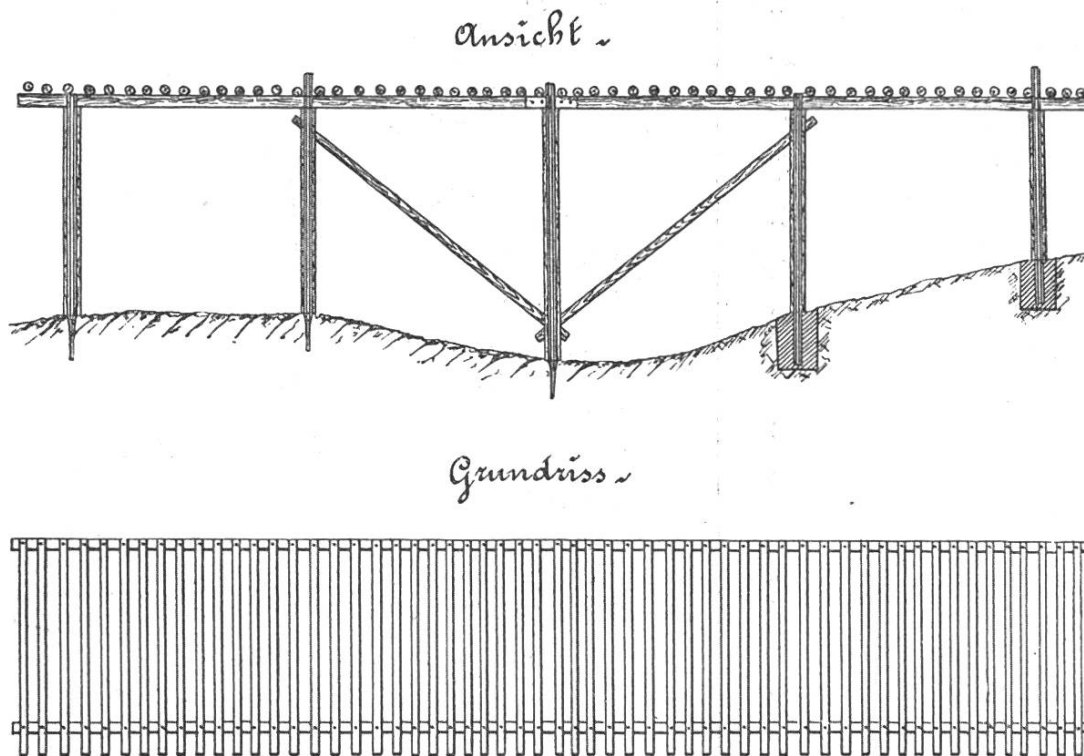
a. Schneebrücke mit Schienenständern. Ansicht und Grundriß. Maßstab 1:200.
